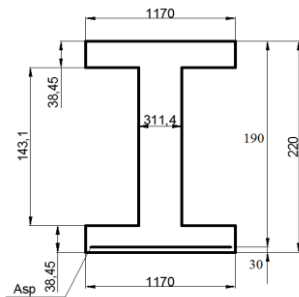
Поперечное сечение многопустотной плиты для расчета по II группе предельных состояний
